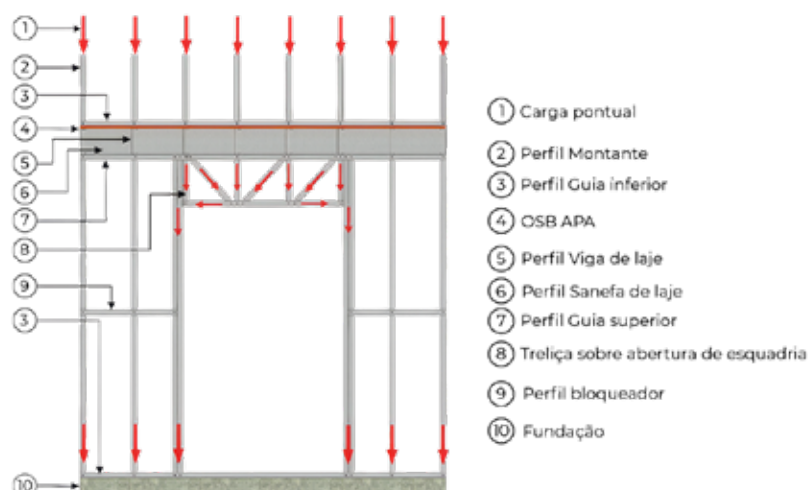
Distribuição das cargas pelos elementos estruturais do sistema
